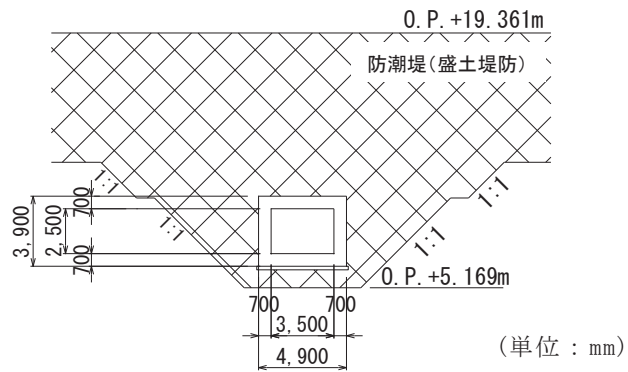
(2) 北側排水路の断面図 (B-B 断面)
